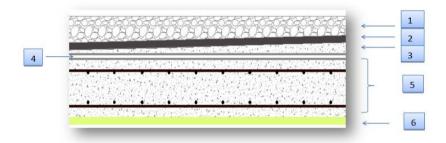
Composants d'un plancher terrasse en dalle pleine.
